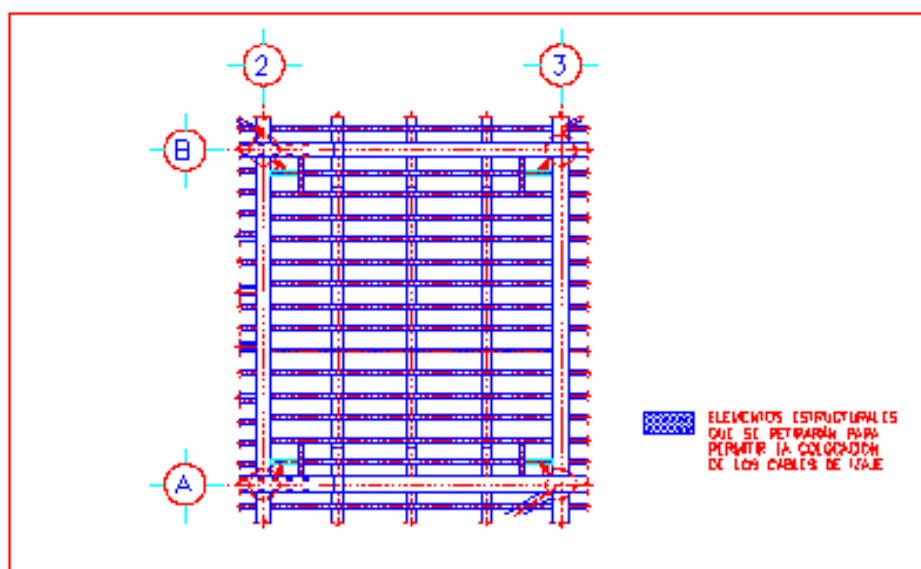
CORTE Y RETIRO DE ELEMENTOS LOCALIZADOS SOBRE LAS OREJAS DE IZAJE
